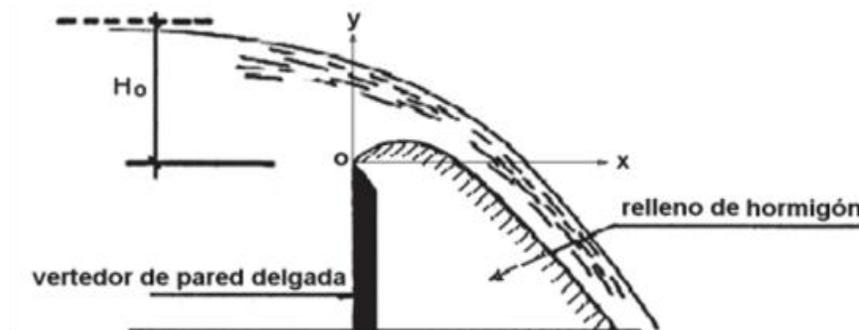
Esquema de un vertedor tipo perfil práctico sin vacío,
